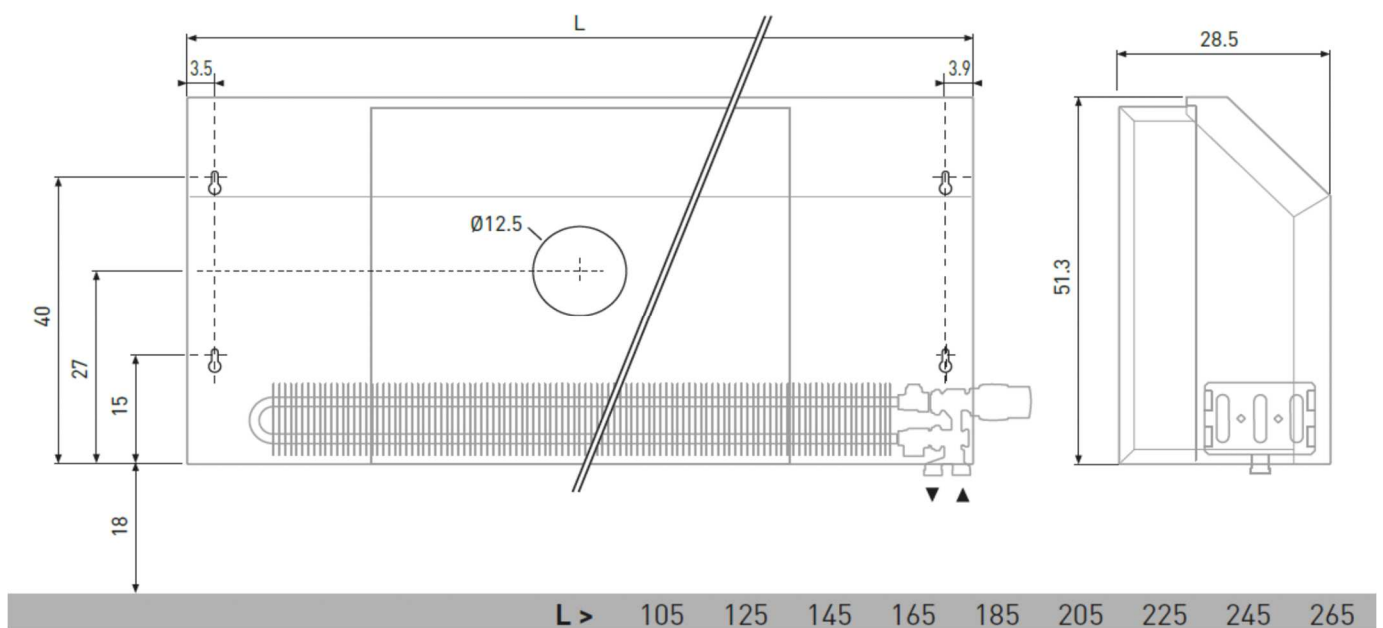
Dimensiones para el montaje de los radiadores Oxygen Hybrid Campus (dimensiones en cm).
